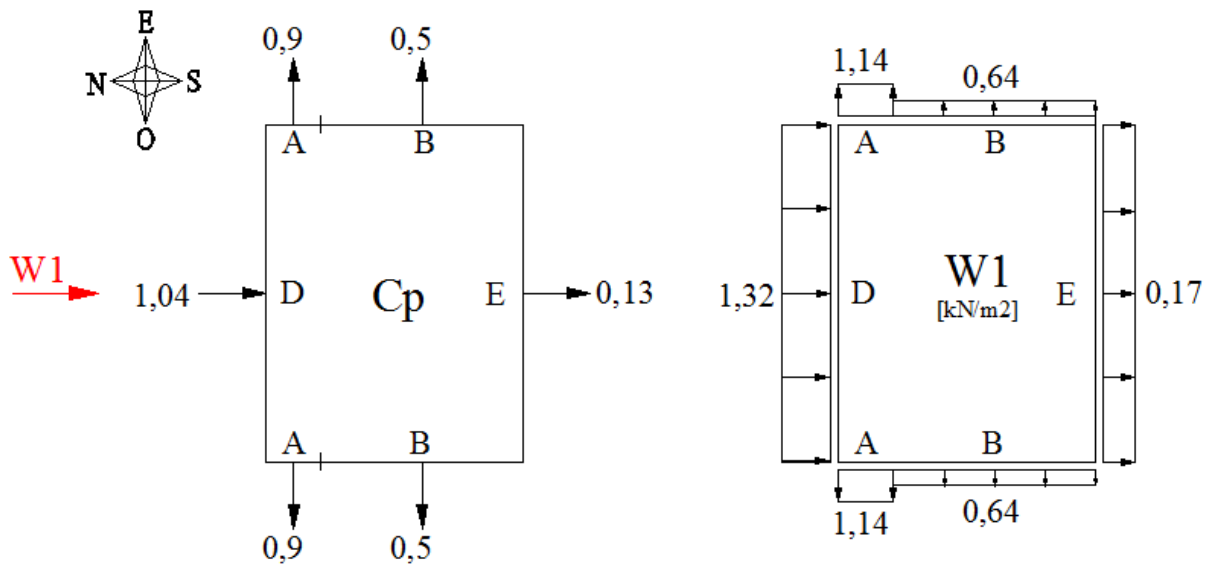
Pressão exercida pelo vento nas fachadas para W1 na situação 2 (EC1.1.4)
